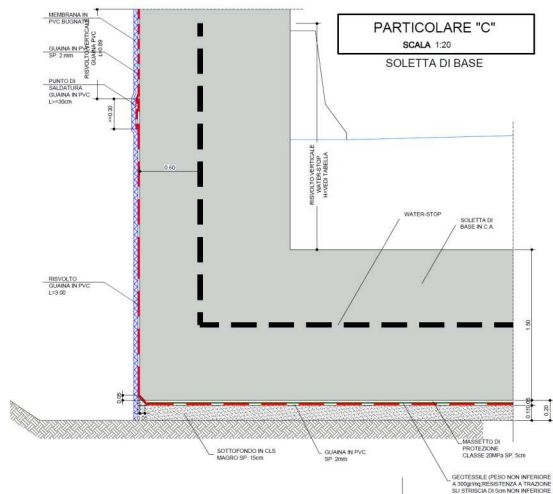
Particolare impermeabilizzazione solettone di fondo (sezione scatolare)
